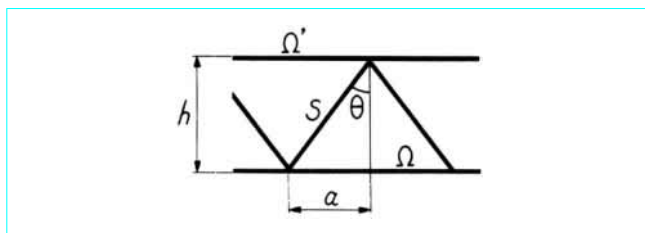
Poutre Warren : assimilation à une poutre en double té
